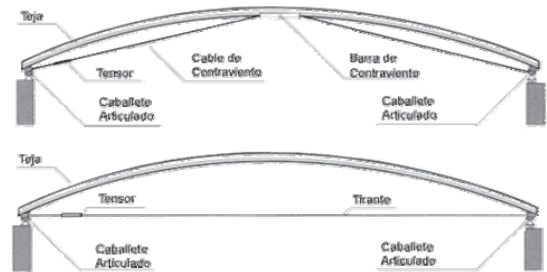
Cubierta autoportante en curvas mediante arcos que pueden alcanzar hasta 30 metros de longitud. Rectas mediante placas rectas que pueden alcanzar hasta 15 metros de longitud. ^{40.2}
